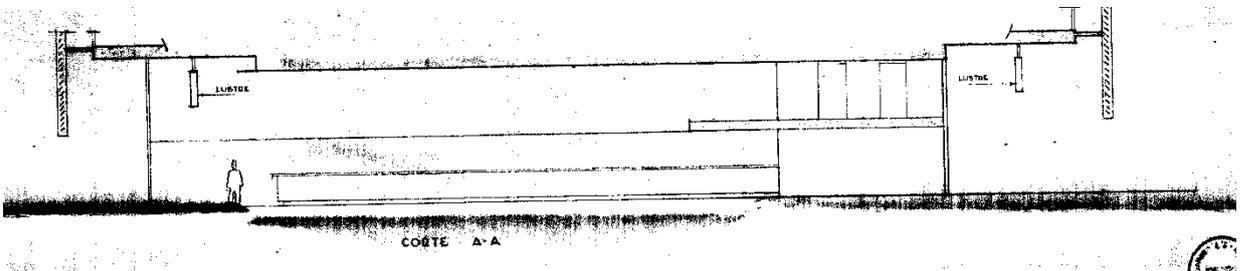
Corte esquemático original, 1963. Nota-se do lado direito o mezanino projetado para as instalações de tecnologia, ocultado pelo pannel artístico visto no térreo, apresentado na foto (ilustração 56). Acervo digital Rino Levi – FAU PUC Campinas
